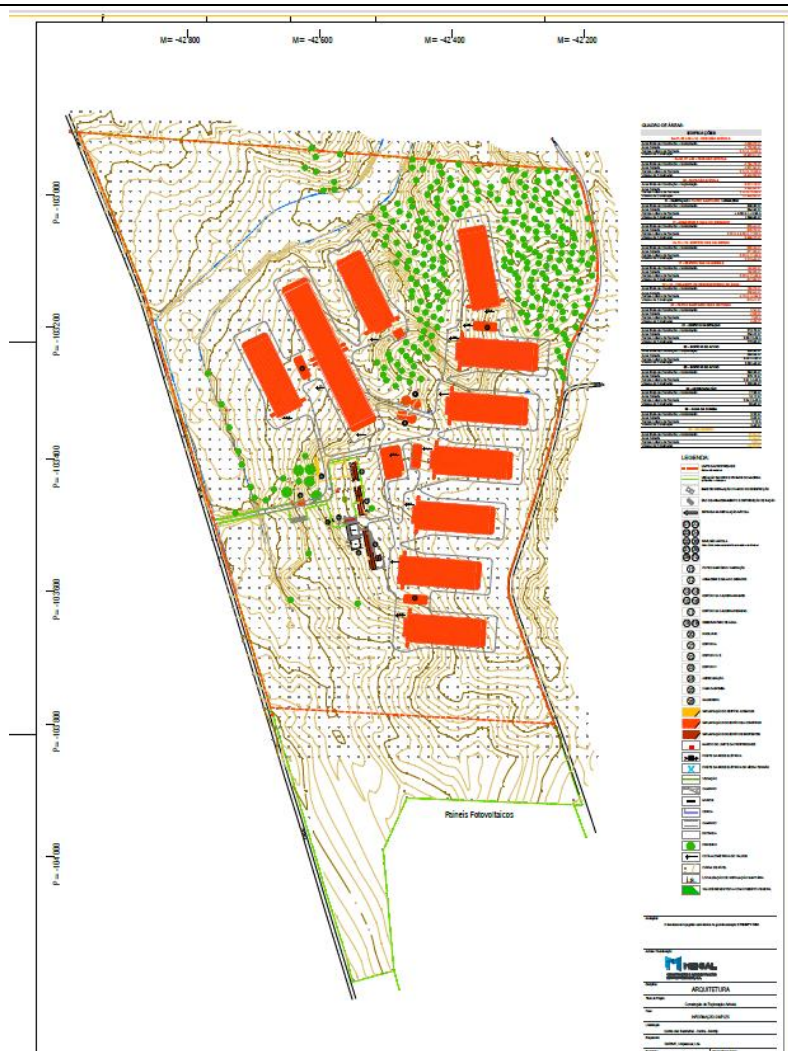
Planta de Implantação (Fonte: Anexos III- v2, agosto 2025)
